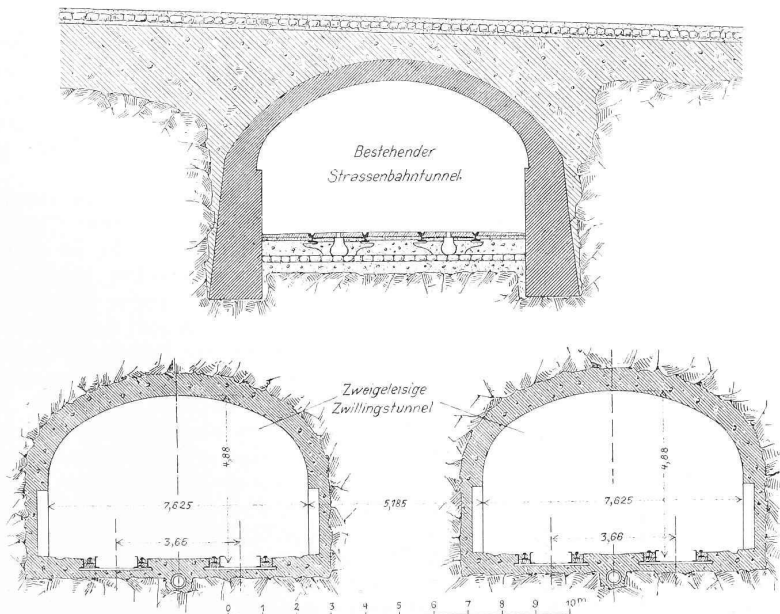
Untergrundbahn. — Normalprofil der Tunnelanlage unter der Park Avenue. — 1 : 200.
